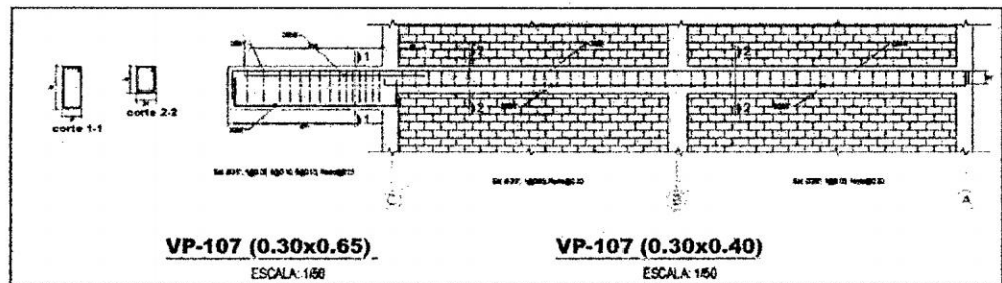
Armado de la Viga Transversal (Y-Y) del eje 1 del primer Piso
